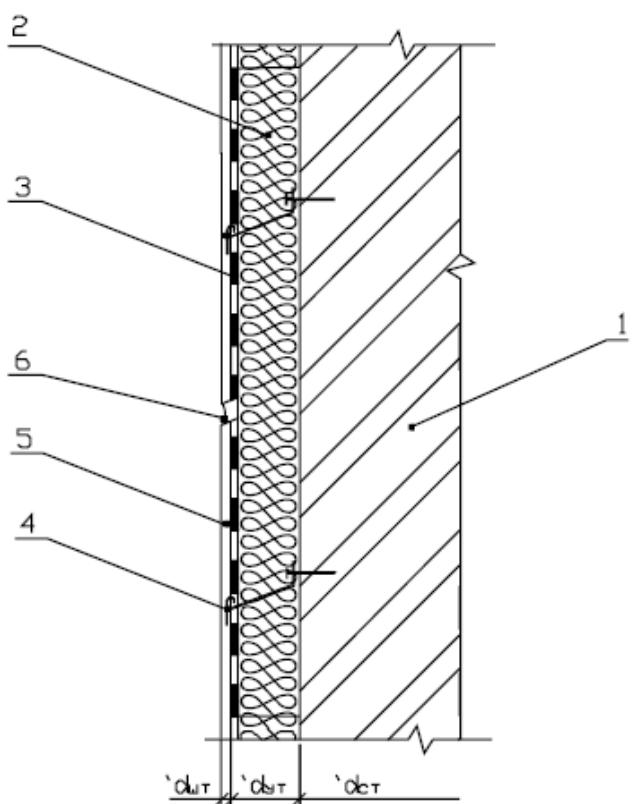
Крепление теплоизоляционной конструкции подвижным элементом крепления.
